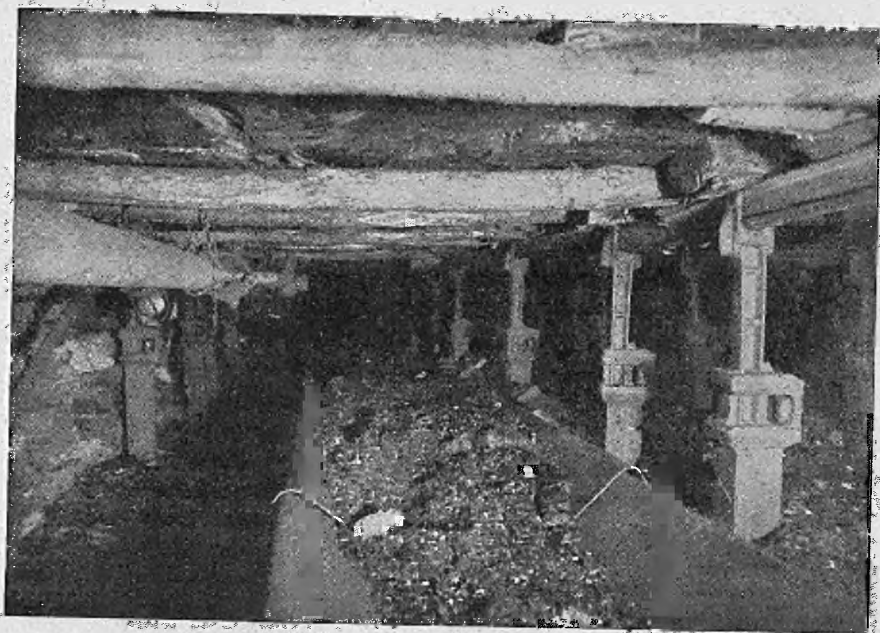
Strebaubau mit Gerlach-Stahlstempel
